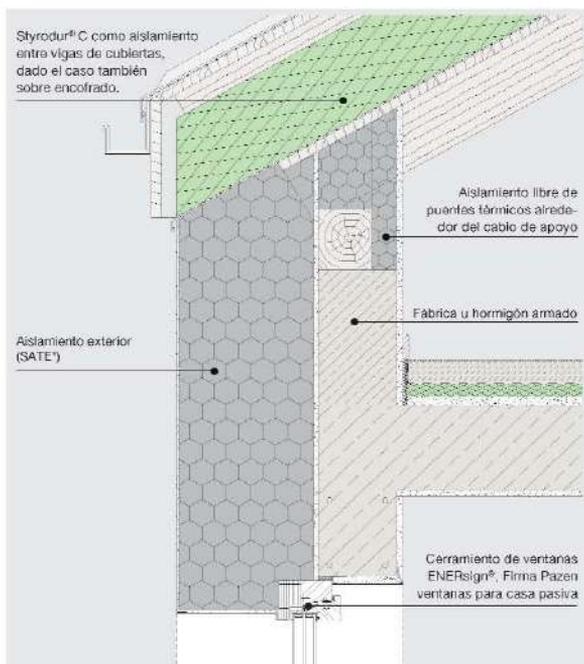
Tachada de cubierta inclinada, diseño de cubierta y canalón.
